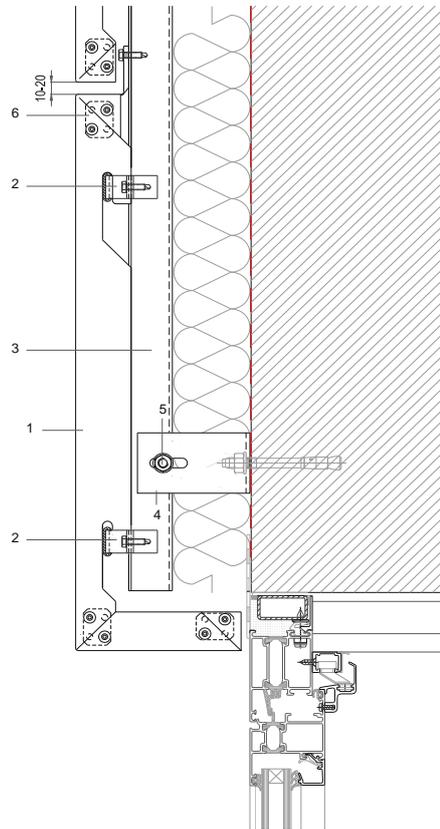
Linteau de baie – Coupe verticale – Mise en œuvre avec profilé LCH-1
